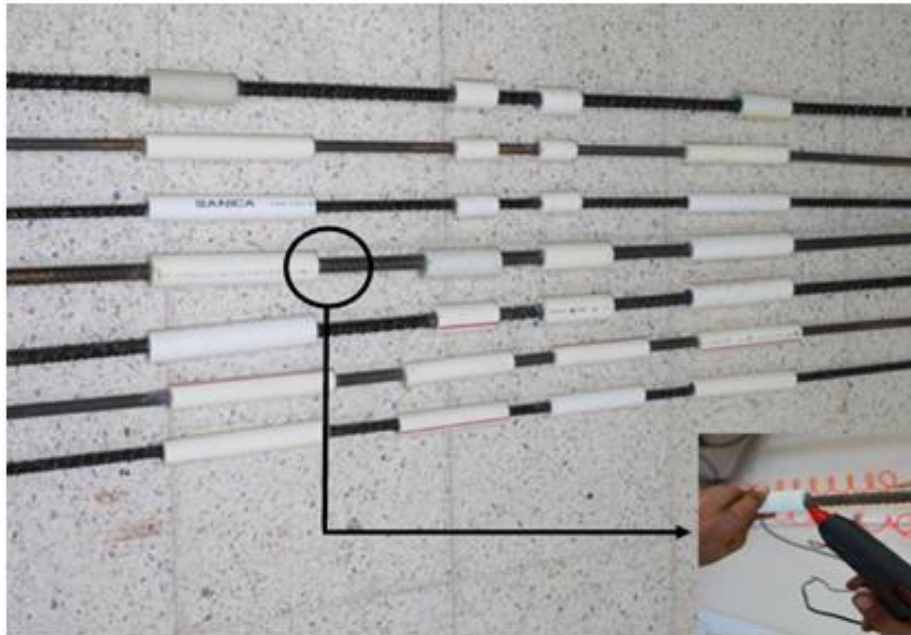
Mafsallı kirişlerde kullanılacak olan kesme donatılarının detayı.
